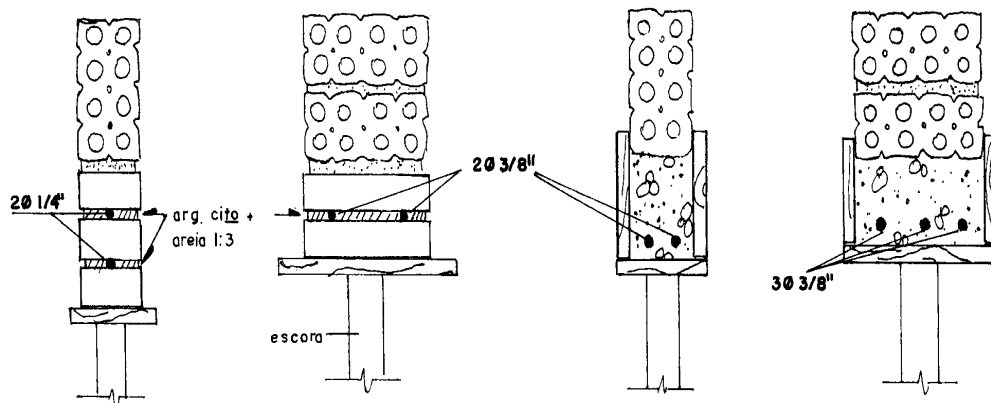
Vergas em alvenaria de tijolo furado para vãos até 1,00m e entre 1,00m e 2,00m
